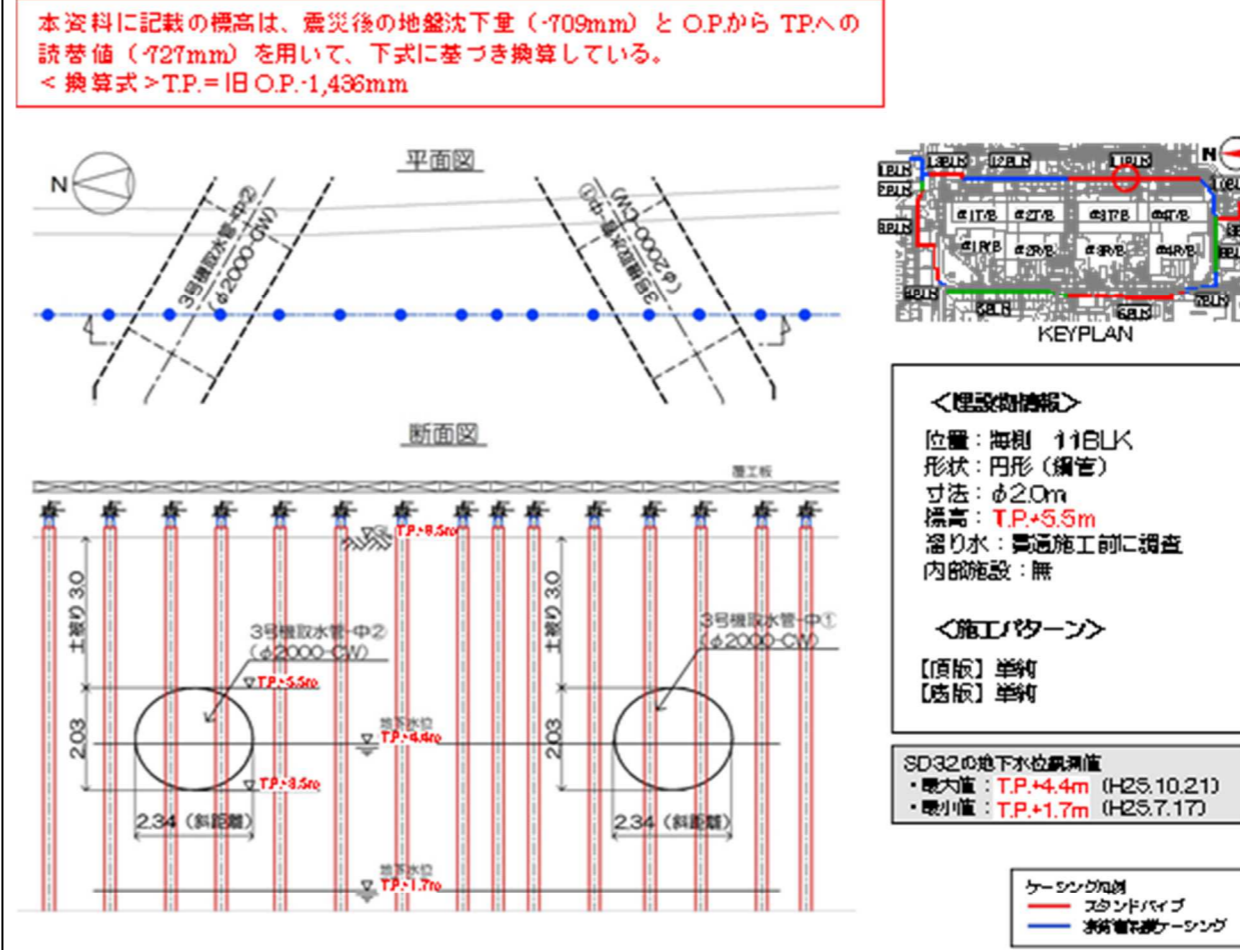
【11-11】3号機取水管-中①② 施工方法 (貫通施工)
